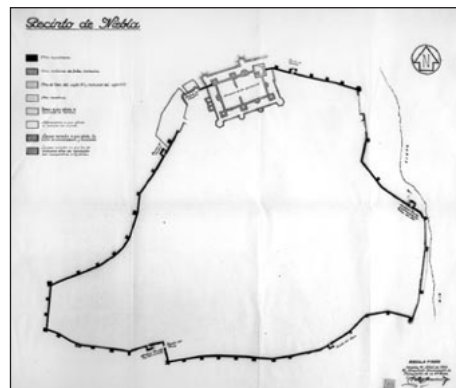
Plano de planta del recinto amurallado de Niebla (Huelva), procedente del proyecto de restauración firmado por Félix Hernández en abril de 1959
